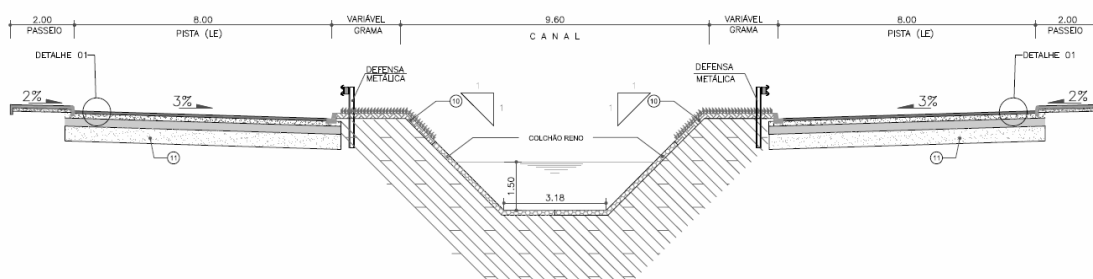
Perfil transversal do acesso 2 ao conjunto de Santa Lúcia
